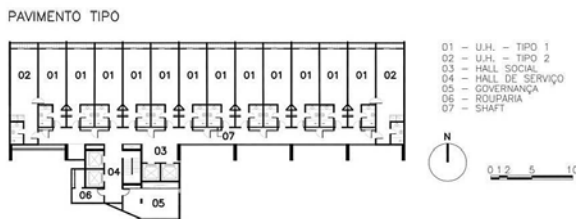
Planta Pavimento Tipo. Fonte: Souza, 2015.
